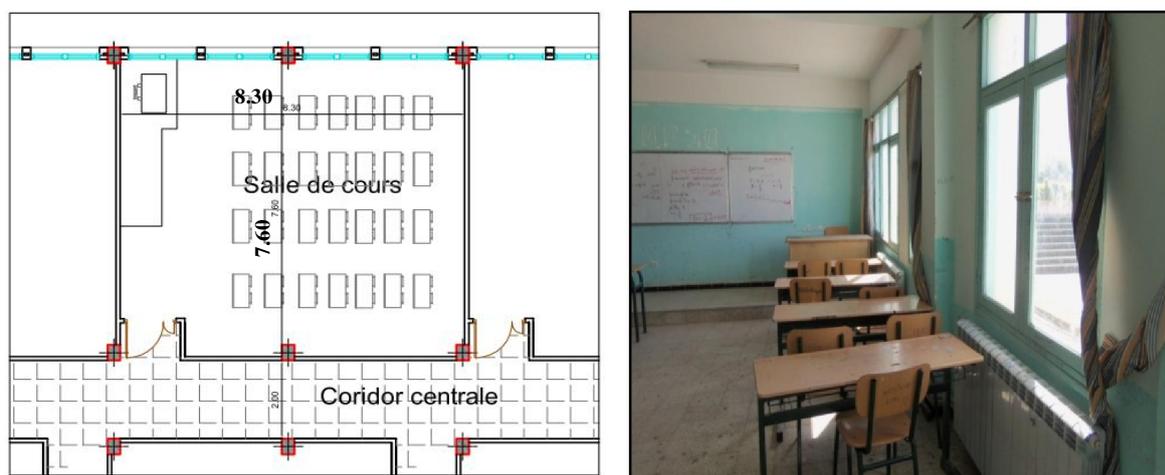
Dimensions et aménagement d'une salle de classe du CEM Base 07.
